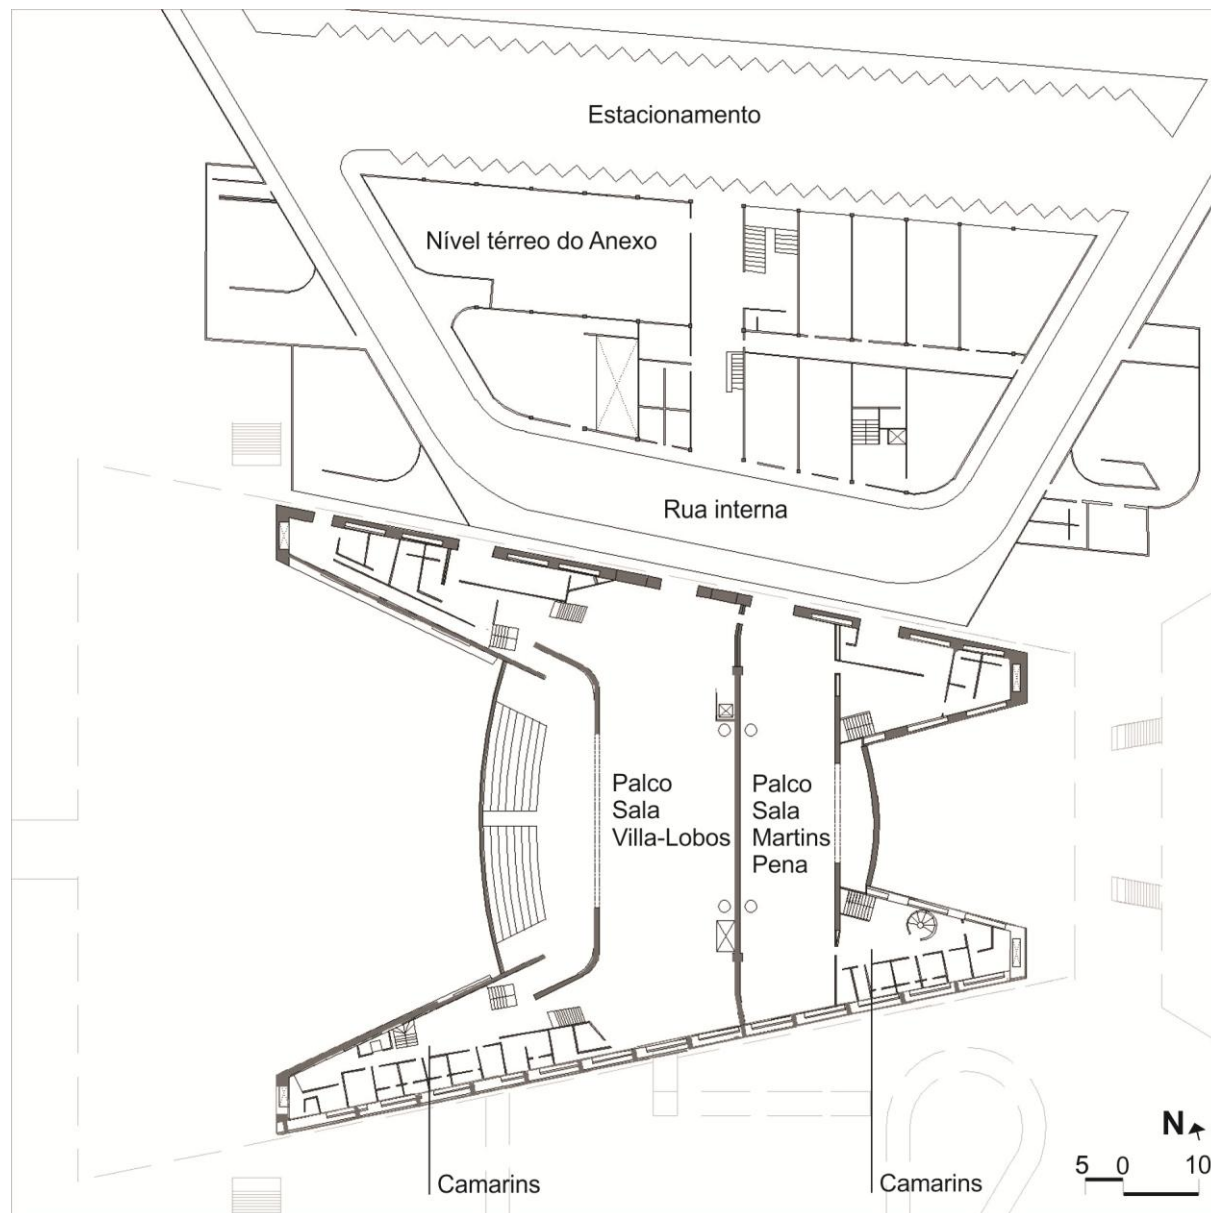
Planta Baixa - Subsolo 3 (-9,00 m).
